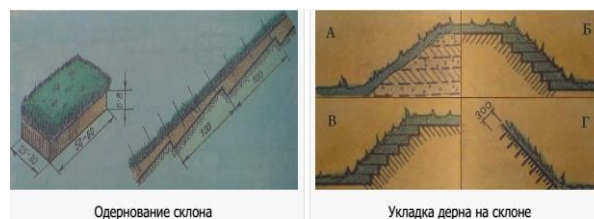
Одернование склона и способы укладки на крутом рельефе
